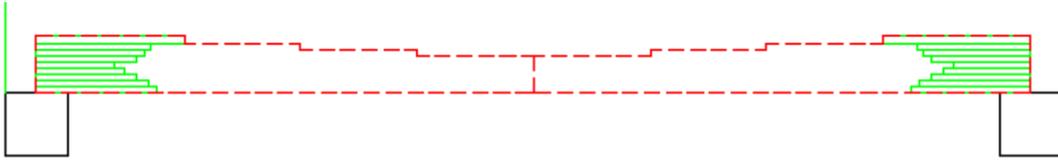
Vista en planta de la puerta en abanico con apertura hacia arriba de garaje, en posición abierta.
